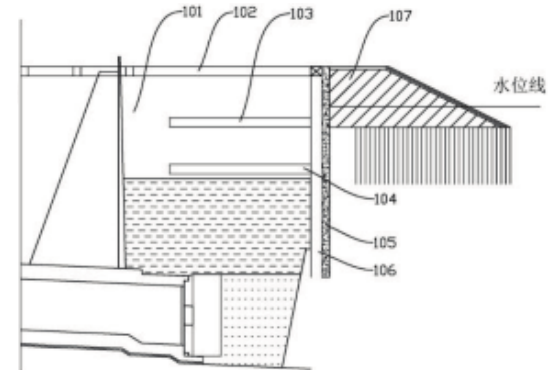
河岸围堰结构拆除施工方法拆除第三道支撑时往基坑内灌水的示意图
